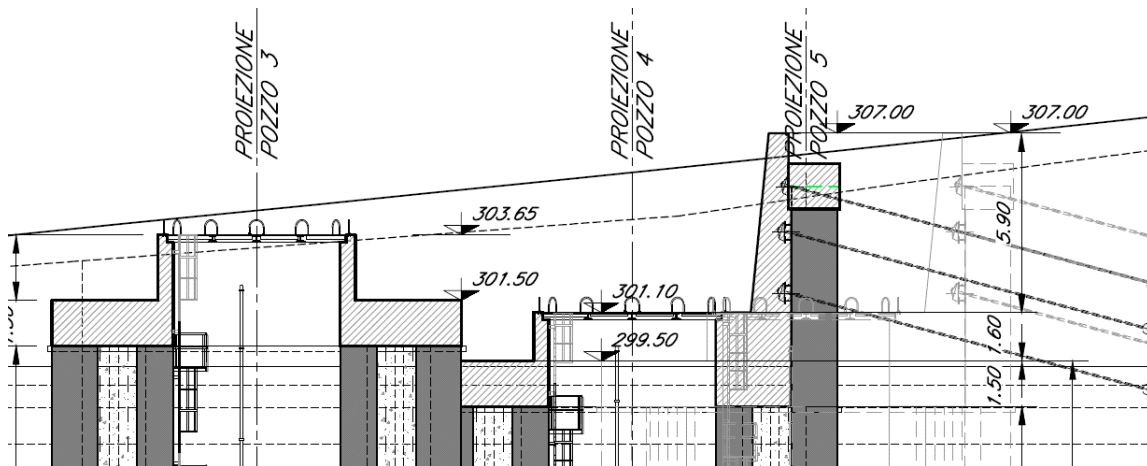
Sezioni muro di placcaggio definitivo Pozzi 4-5
